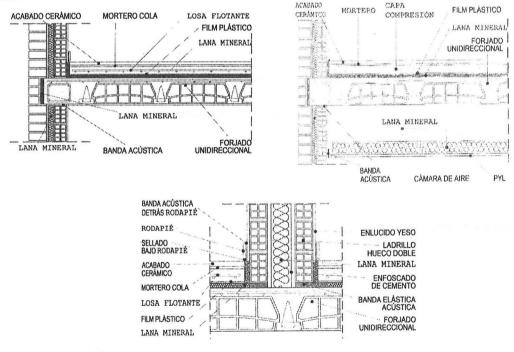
Detalle de losas flotantes y su encuentro con las paredes.
